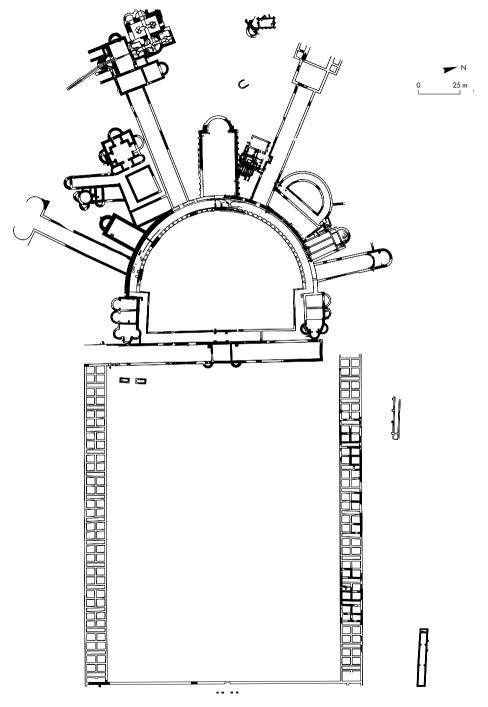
Planta del palacio con la incorporación de la nueva fachada.
